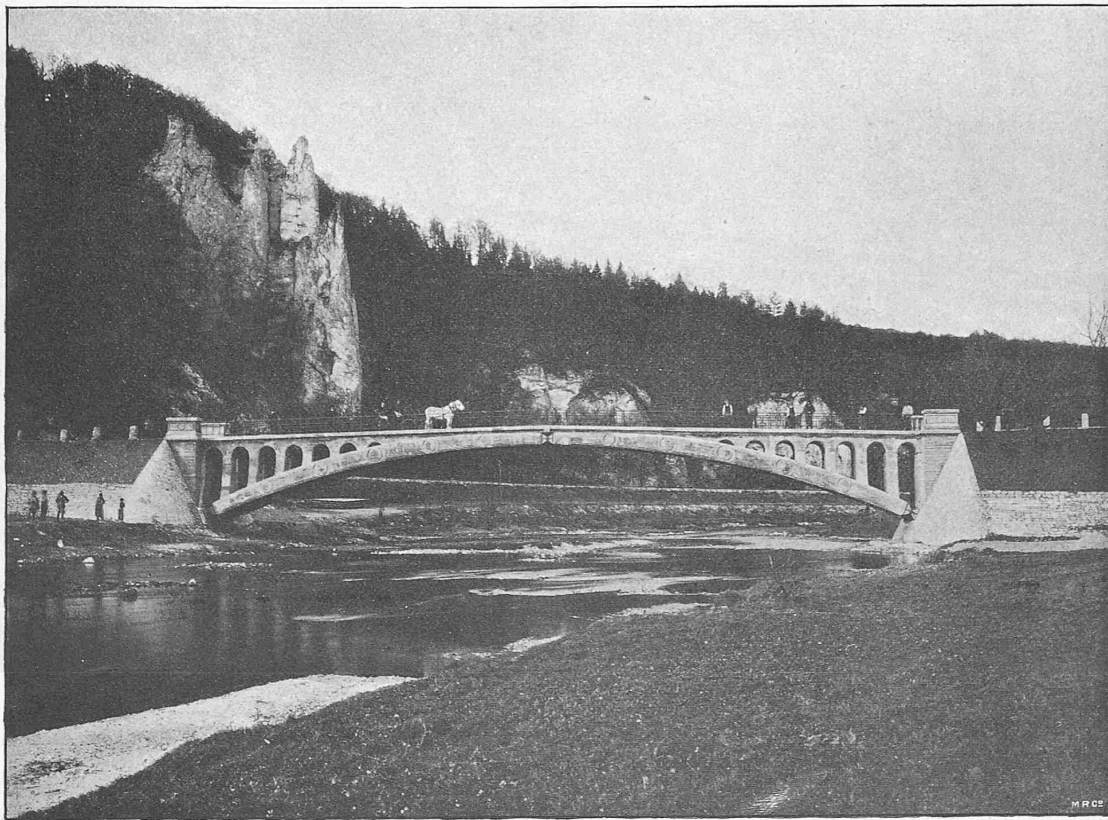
Stampfbeton-Brücke über die Donau bei Inzigkofen.
